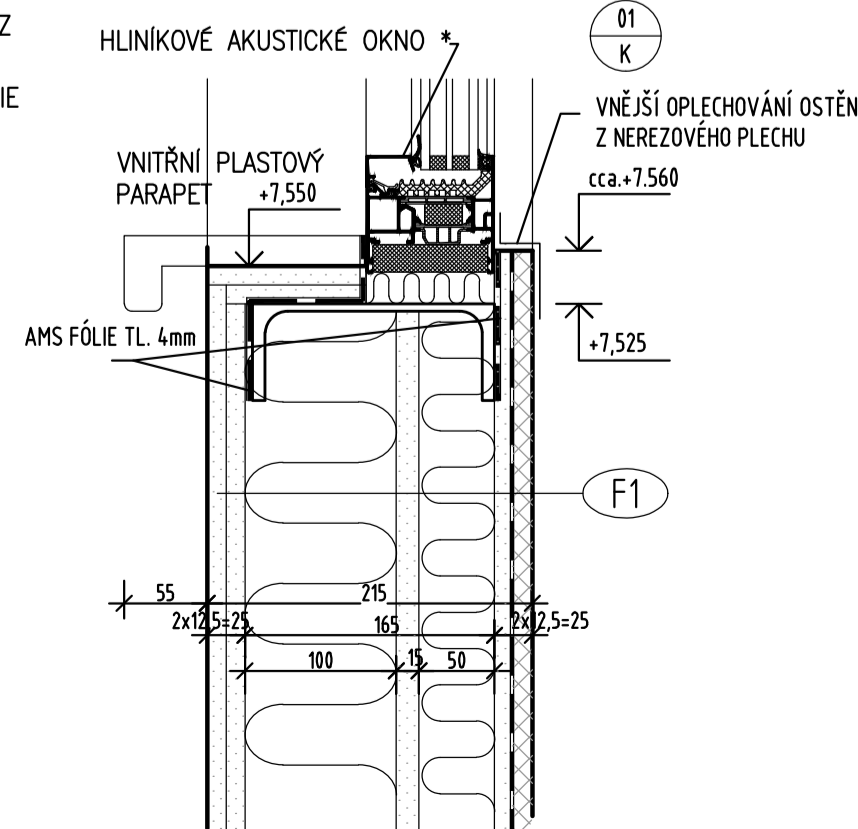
ŘEZ (SKLADBA STROP/STĚNA)
